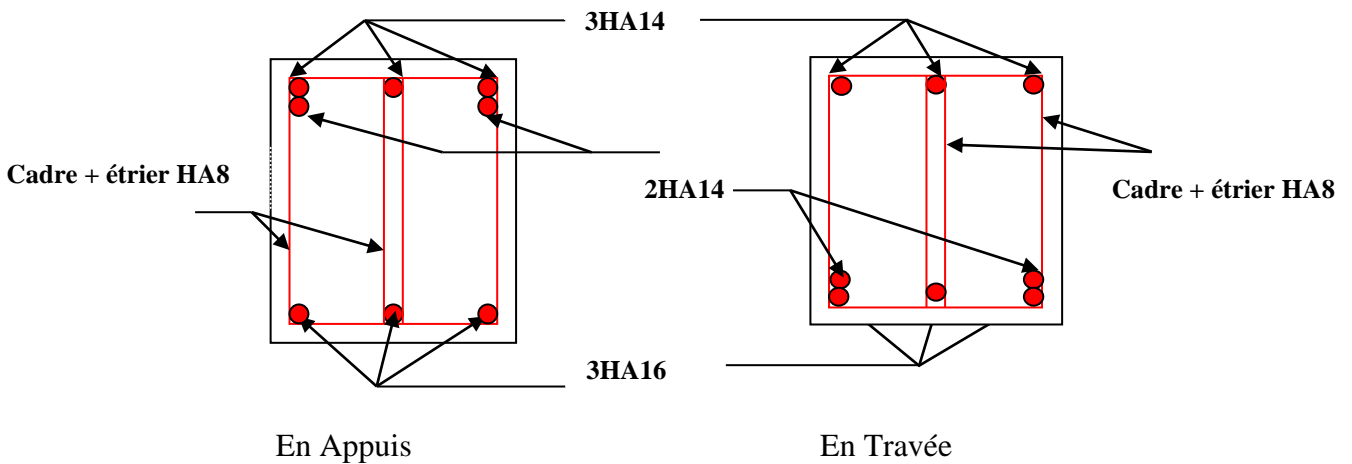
Schéma de ferrailage de la poutre palière (palier de départ)
